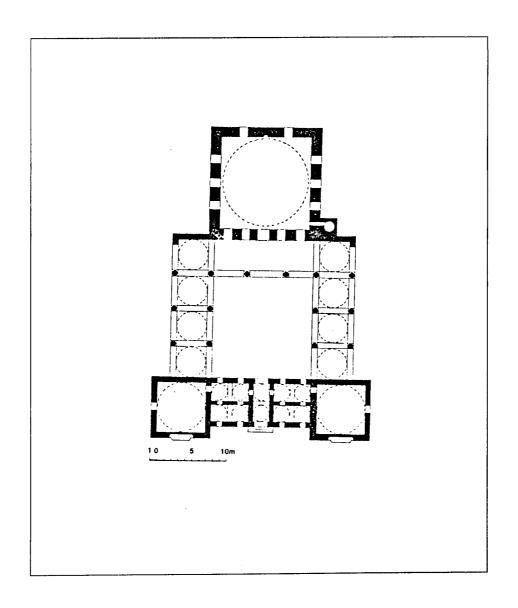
مسقط أفقي لمجمع السليمية في أدرنة (عن :Cezar) .
